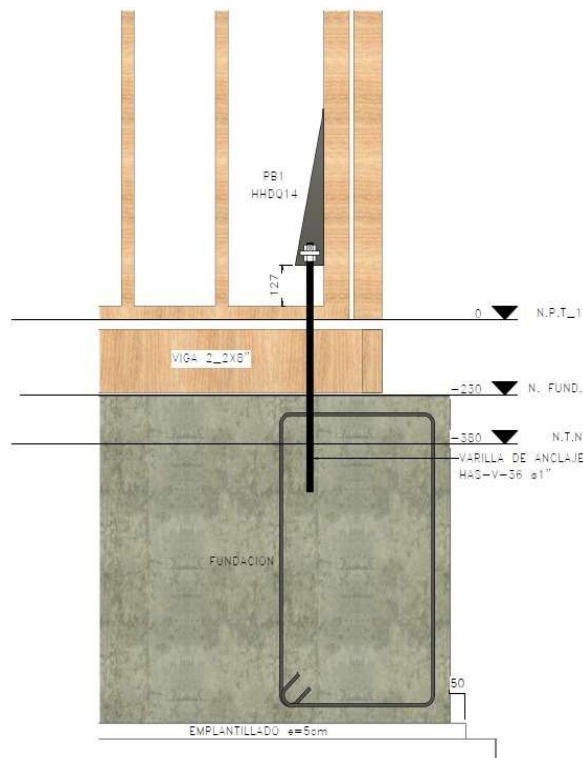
Detalle penetración Varilla Anclaje. Fuente: Simpson Strong-Tie
